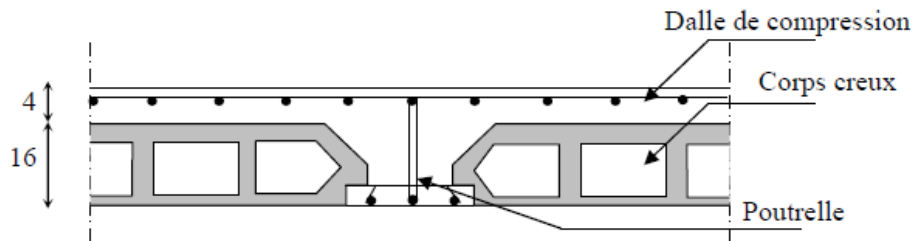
Coupe transversale d'un plancher à corps creux
